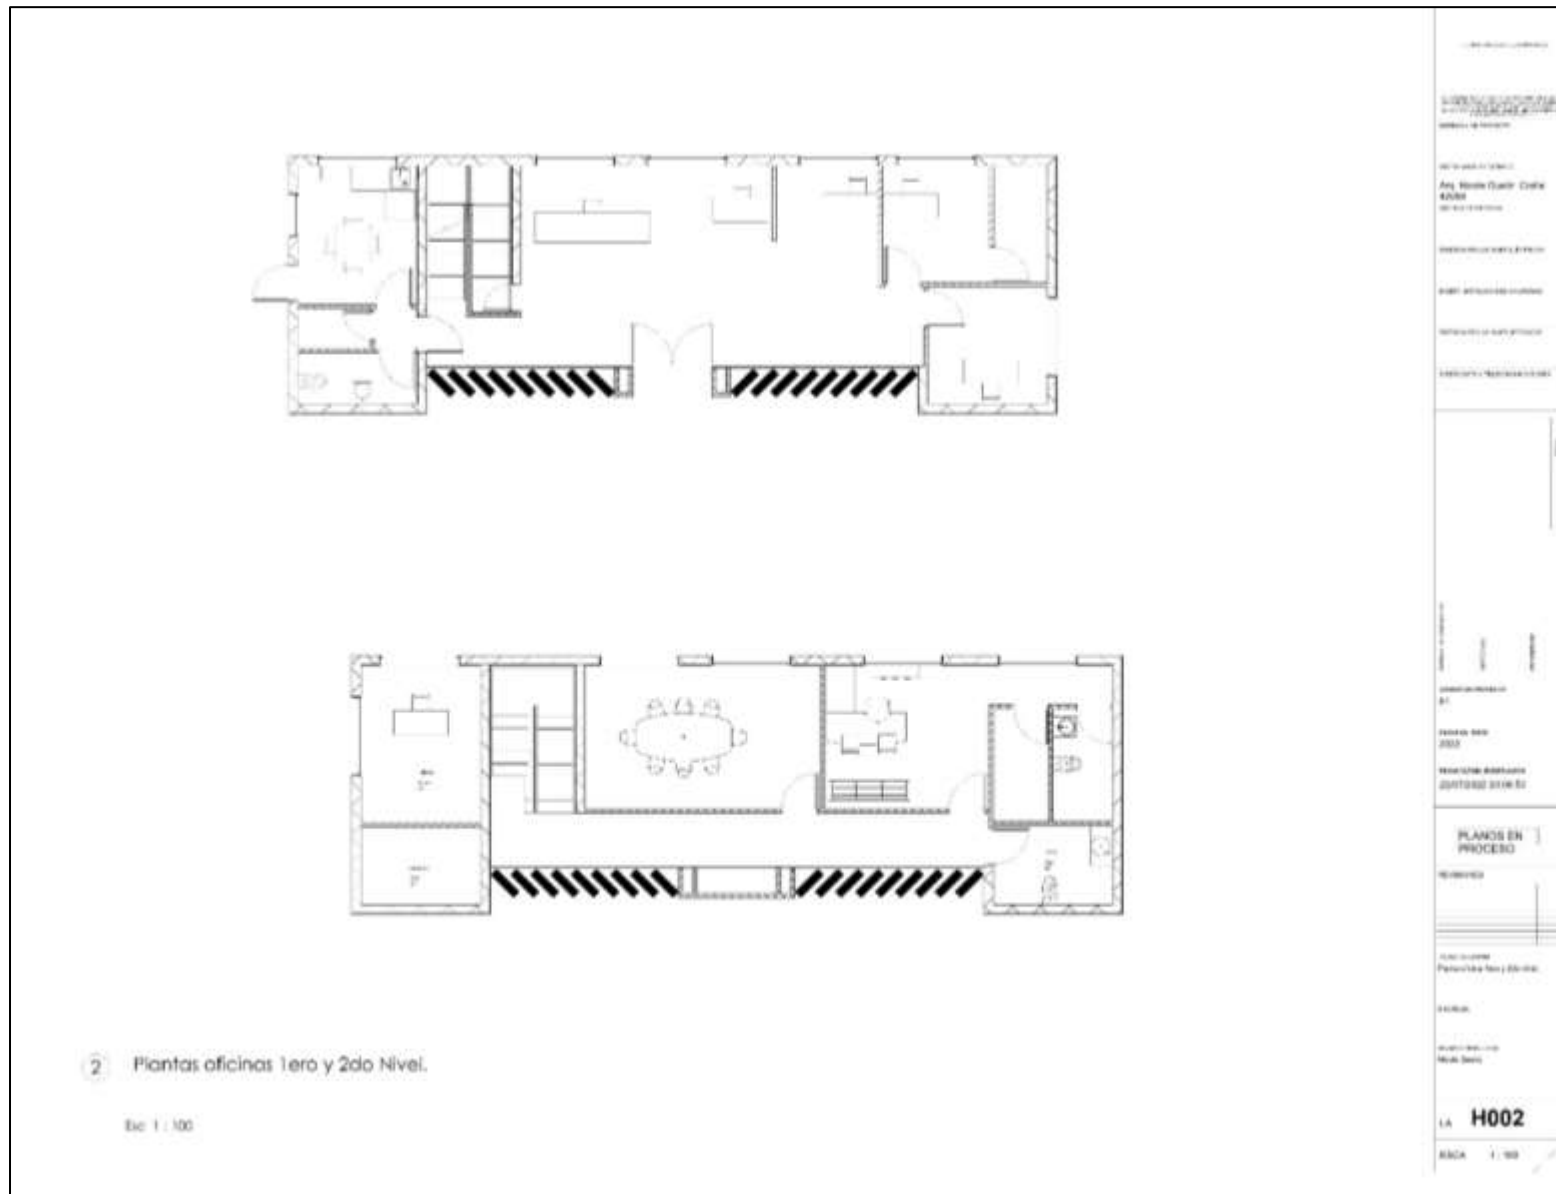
Plano de planta oficinas 1er y 2do nivel
